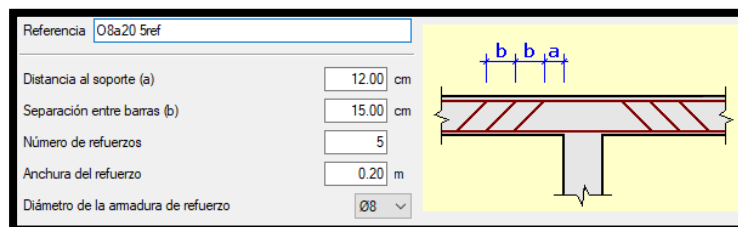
Criterios de cálculo ante punzonamiento
